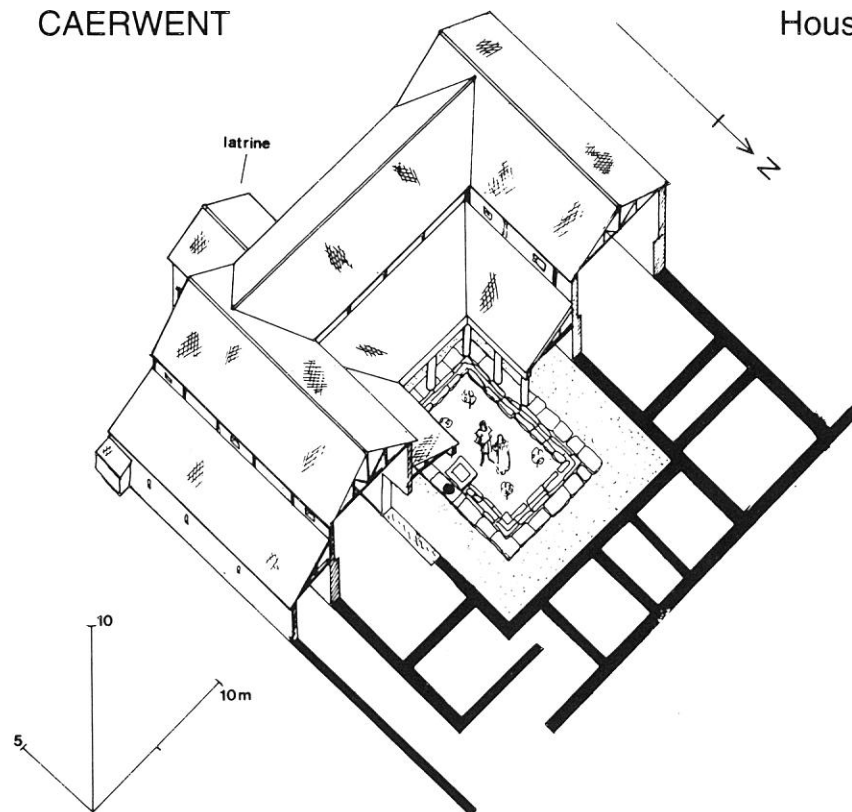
Venta Silurum*: planimetria della casa III,S. (Da Guy de la Bédoyère 1991).
